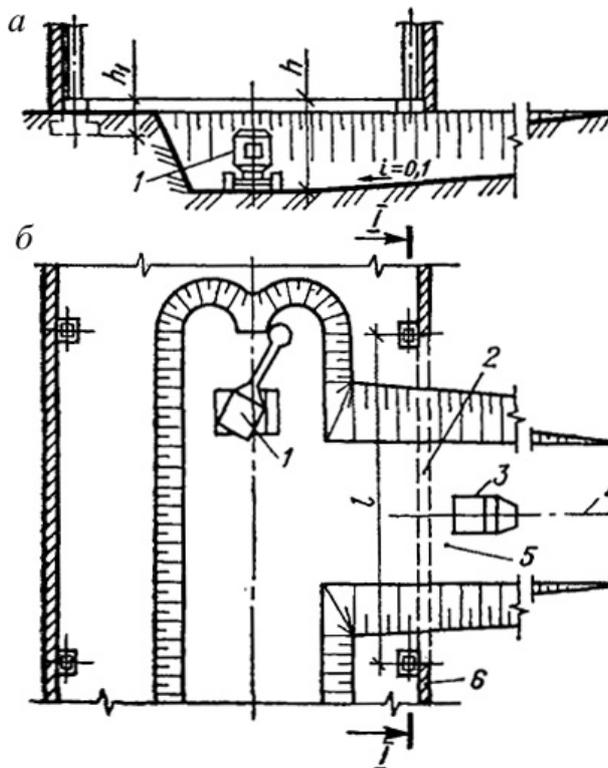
Схема разработки грунта в котловане с устройством пионерной траншеи: *a* – продольный разрез; *б* – план; 1 – экскаватор (прямая лопата); 2 – разбираемый проем; 3 – автосамосвал; 4 – ось пионерной траншеи; 5 – пионерная траншея; 6 – стеновая панель
